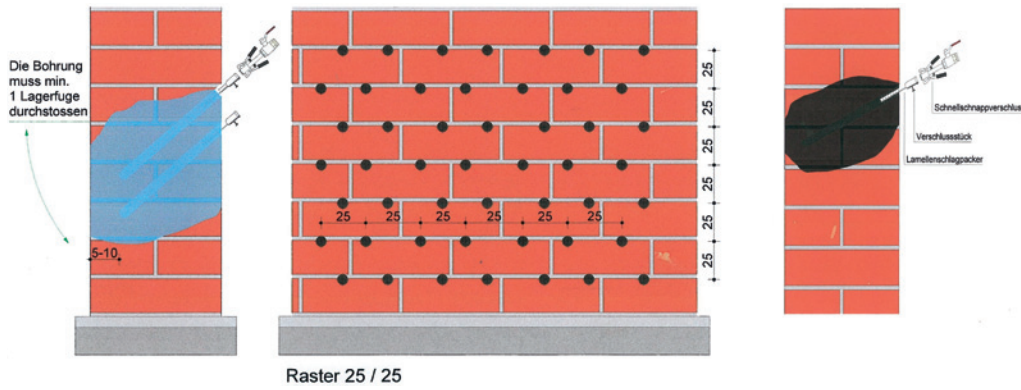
Mauerwerksinjektion mit Wasserglas und Mikrozement – 2 Stufen – Schema
